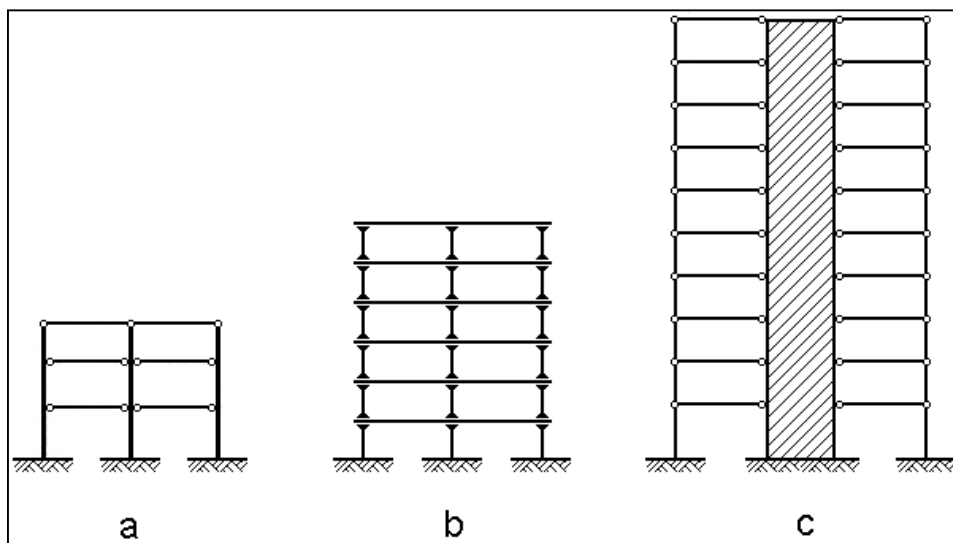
Grundsysteme zur Aussteifung von Stahlbeton-Skelettbauwerken [4]
